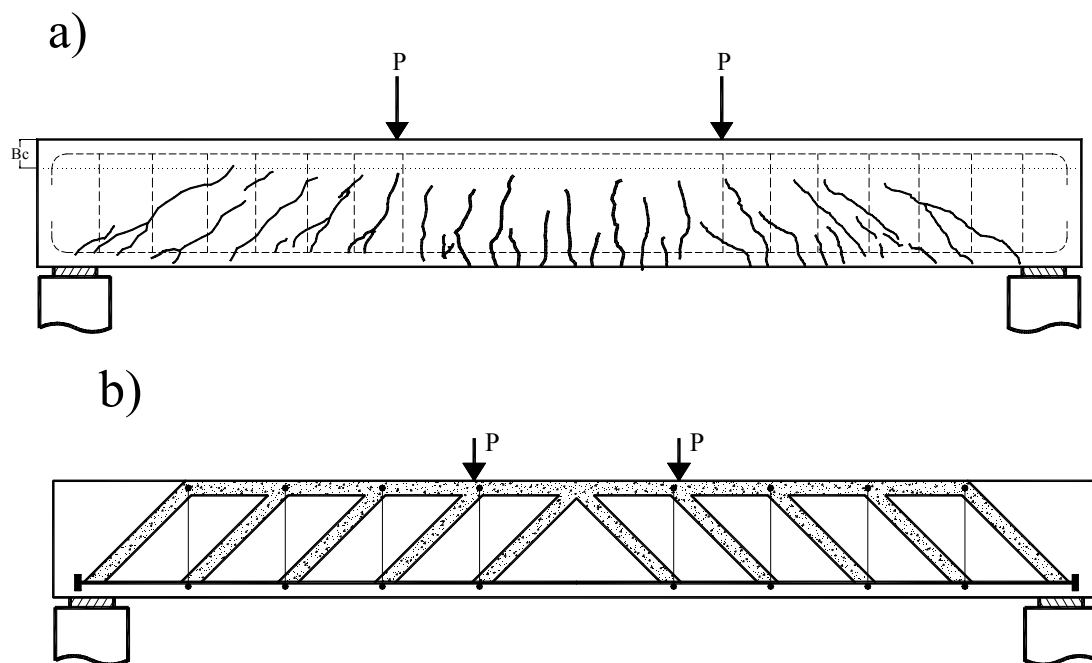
a) Viga de concreto armado fissurada; b) Analogia de treliça - de Fusco (1977)
